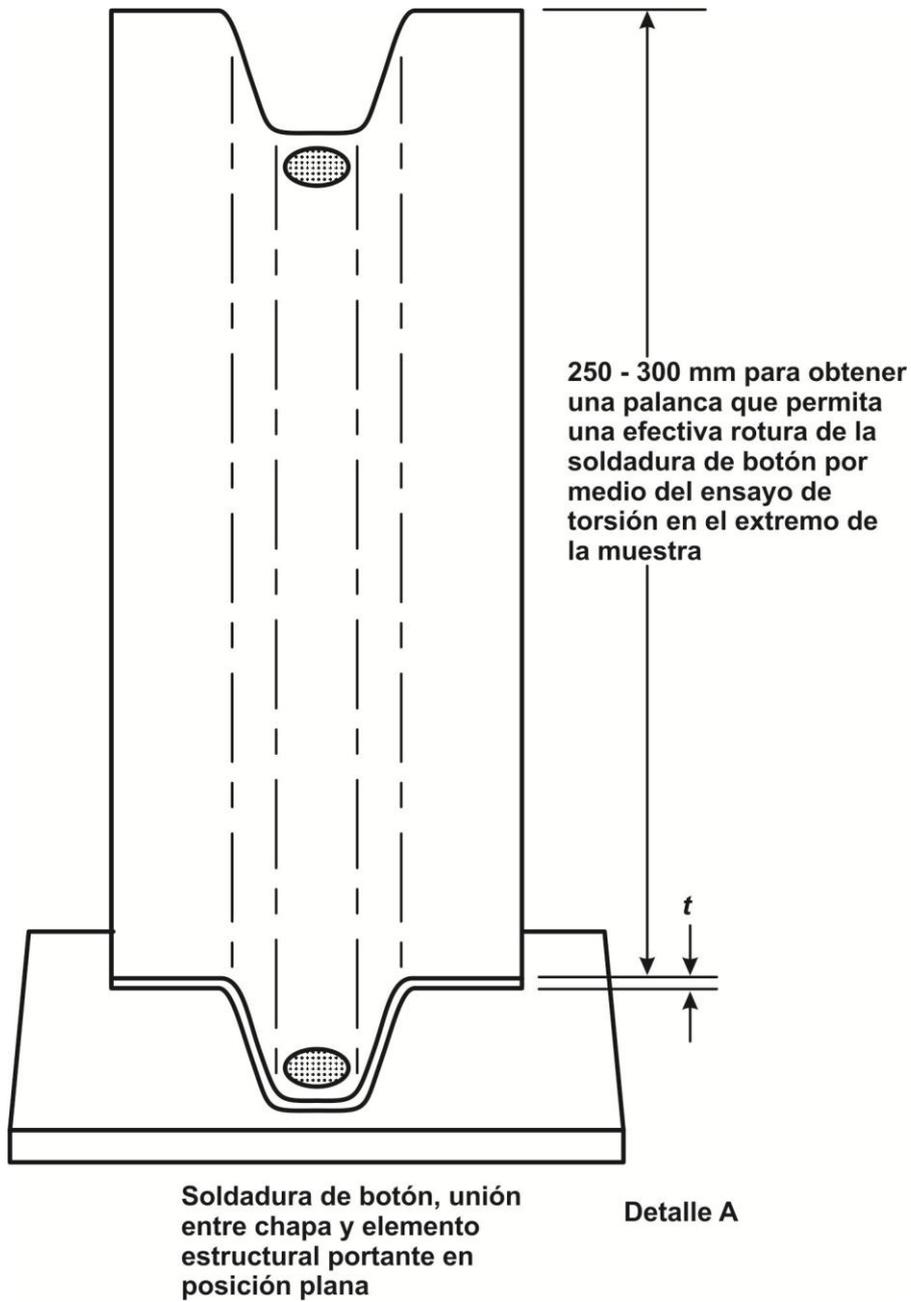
Esquema de ensayo de soldadura de botón.
